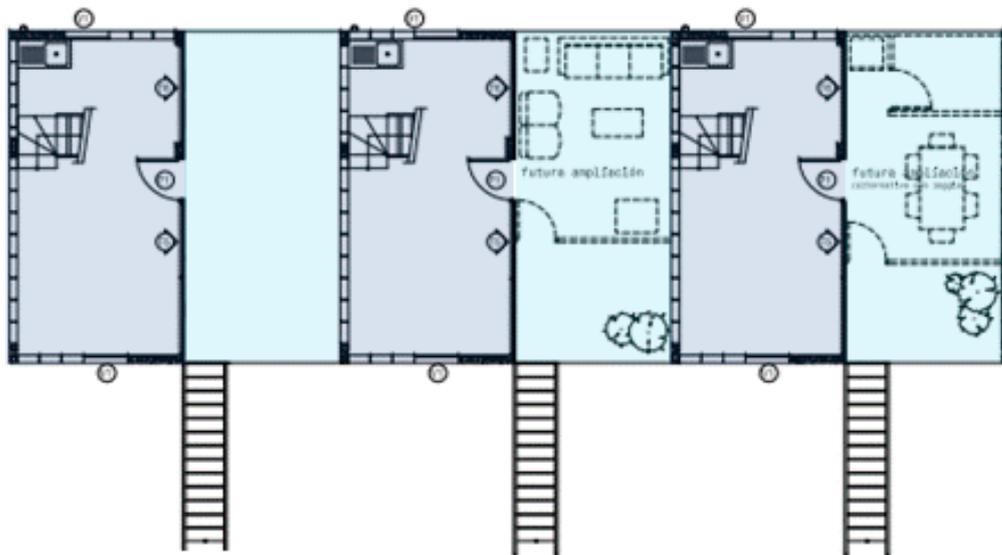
Planta 1º Pavimento Unidades Térreas
